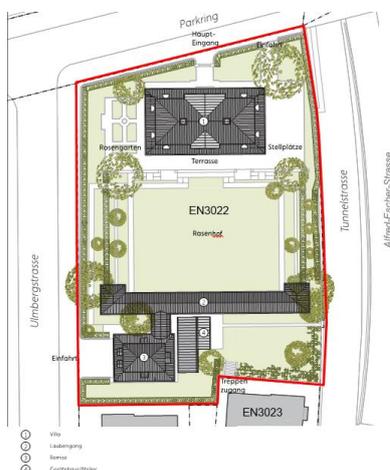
Geltungsbereich des Gestaltungsplans (rot); Dachaufsicht Bestand
